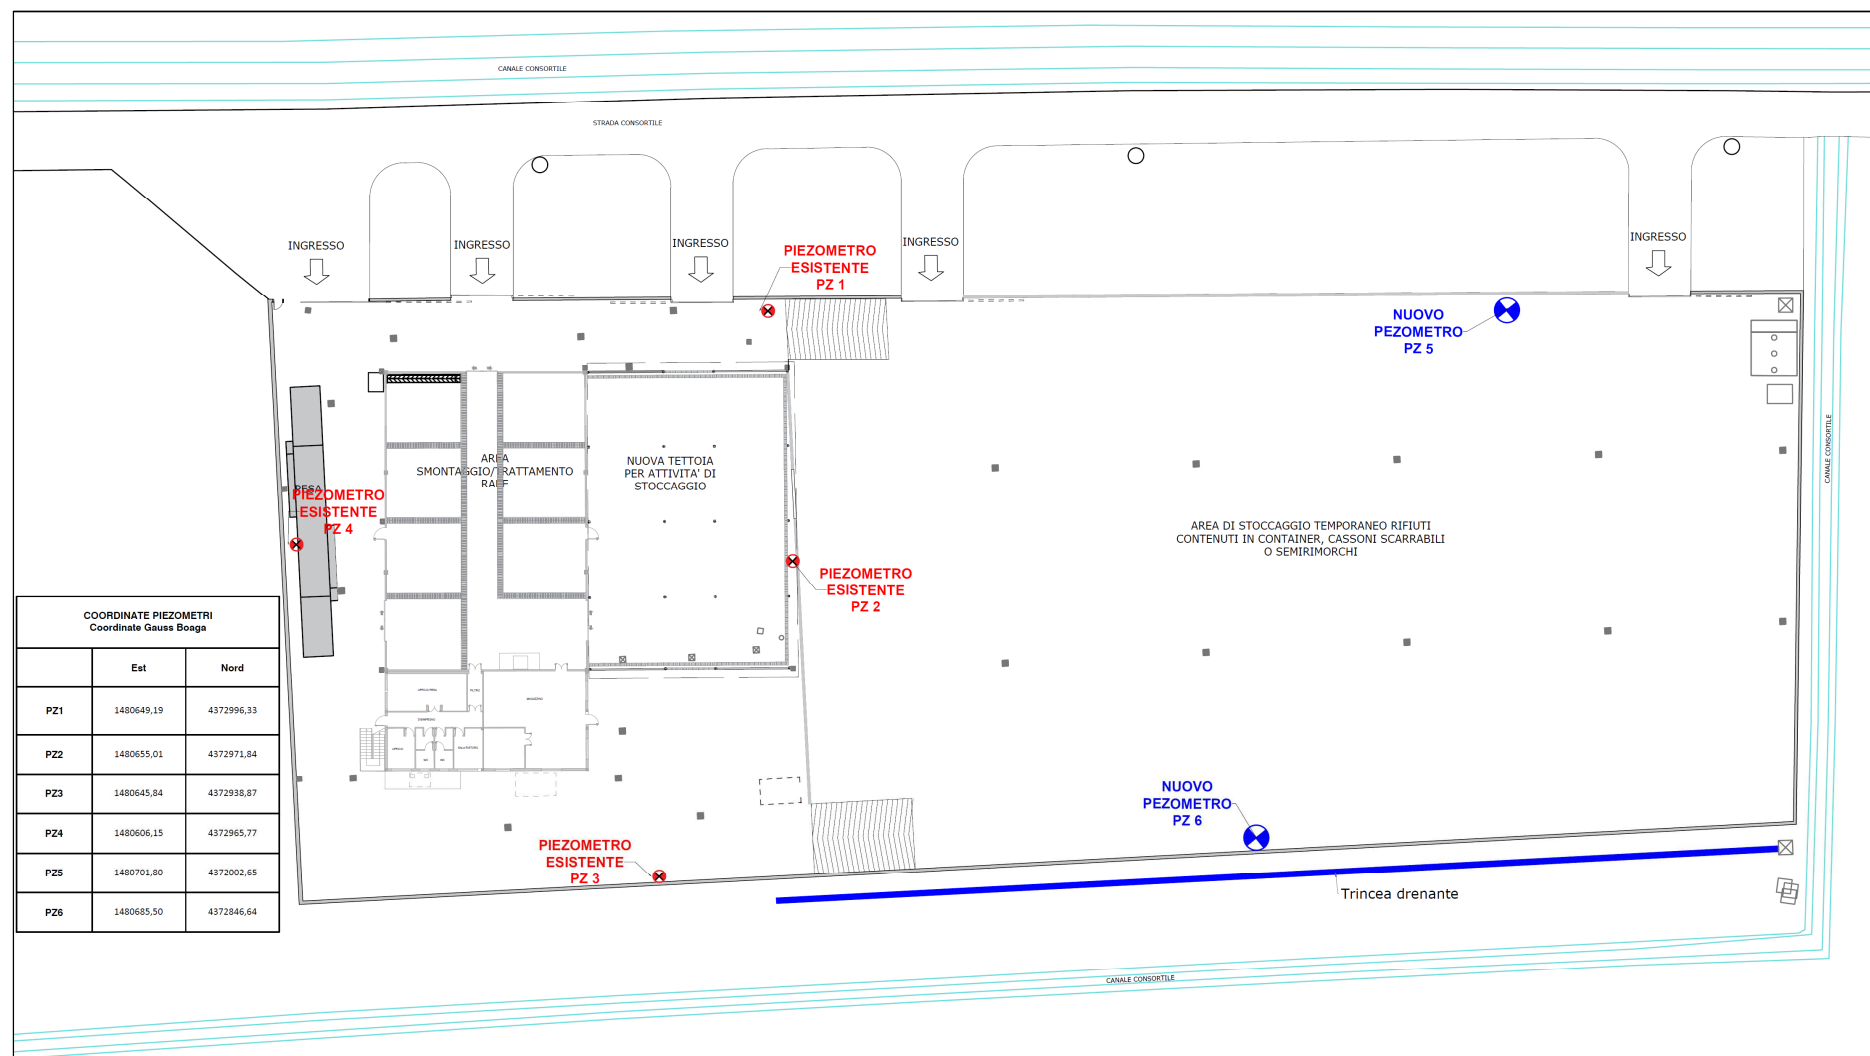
Riferimento tabella C15 - Planimetria piezometri
